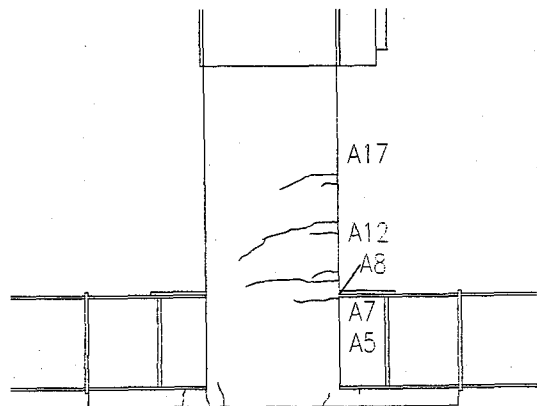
TYPE 2 1.0 δ_y 載荷時橋脚ひび割れ図
